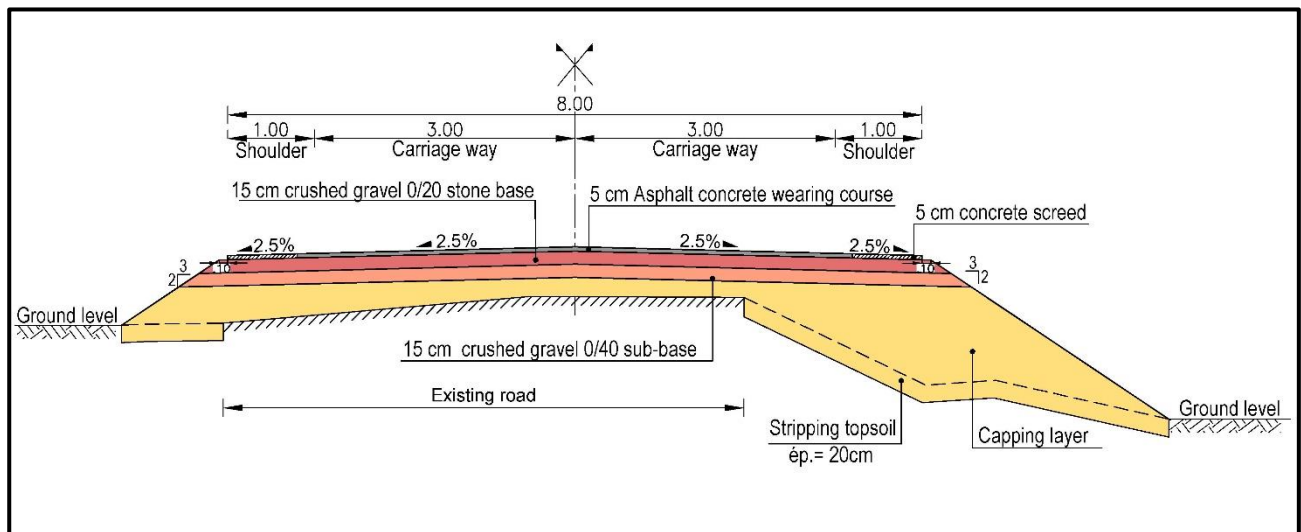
Secção transversal típica 1- Estradas de acesso à ponte sobre o rio Lembá
